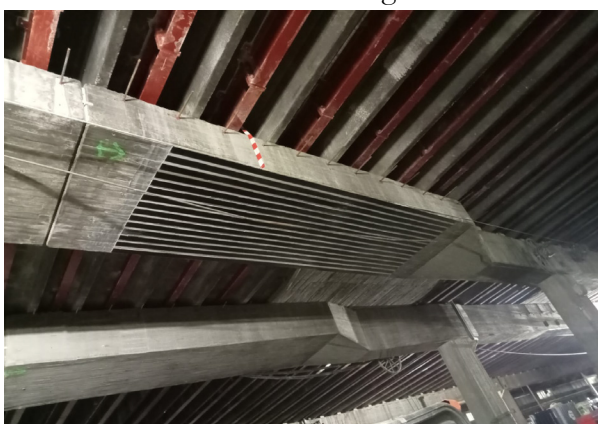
Barras de refuerzo horizontal para ménsulas laterales
